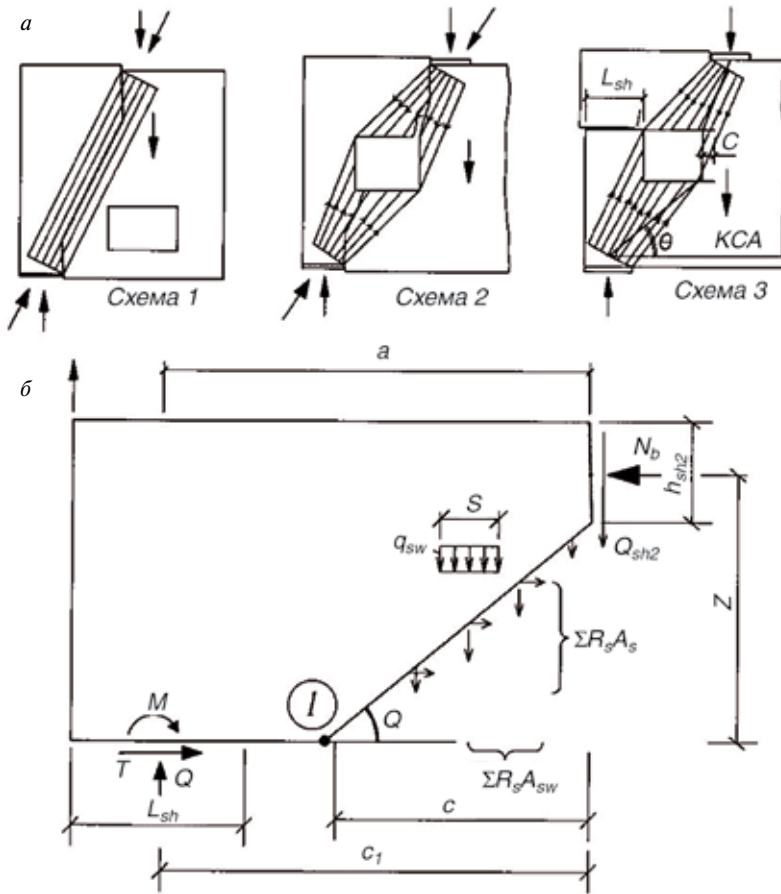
Расчетные схемы балок-стенок с отверстиями
